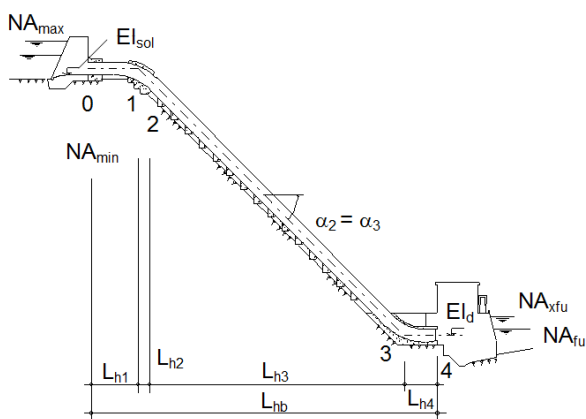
Perfil esquemático de conduto forçado com três trechos
